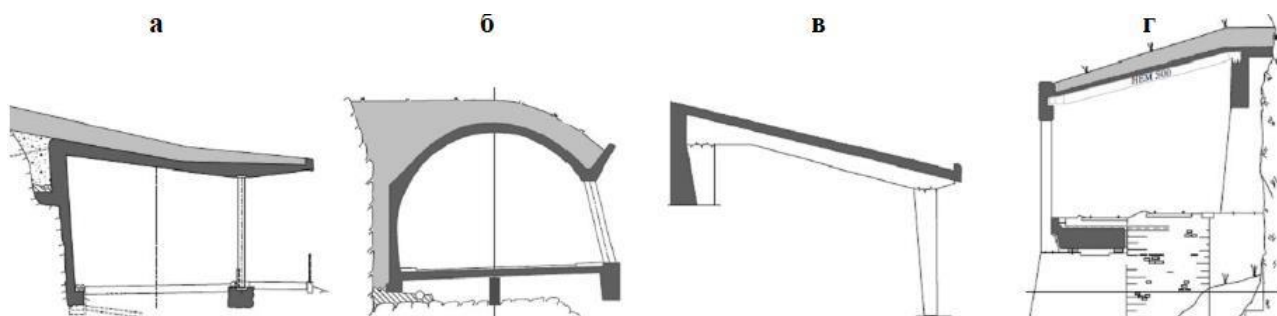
Различные типы конструкций противокаменных галерей (жесткие основные конструкции показаны черным цветом, амортизирующий материал – серым): а – железобетонная плита; б – железобетонная арка; в – монолитная железобетонная конструкция; г – композитная конструкция из стали и железобетона (Vogel et al., 2009)
